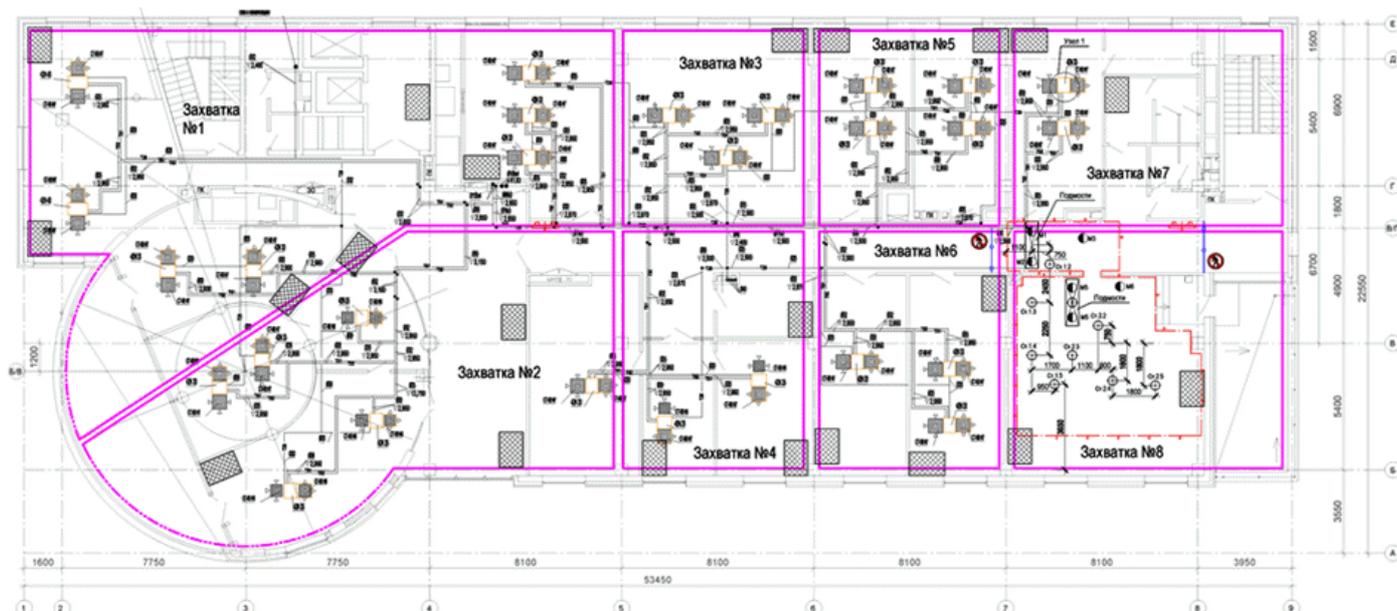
Схема монтажа трубопроводов системы холодоснабжения
